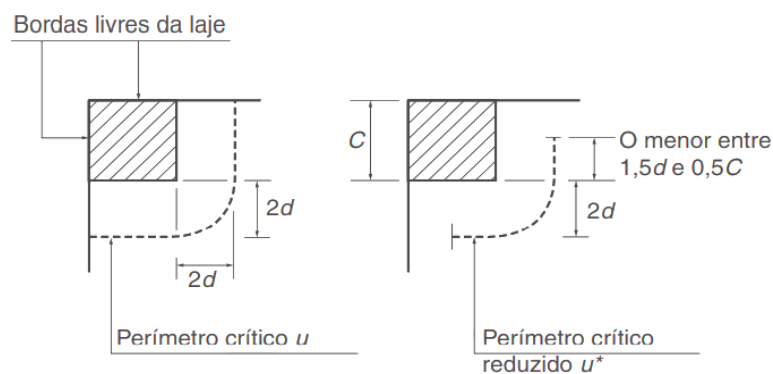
Perímetro crítico em pilares de canto. (NBR 6118:2014).
